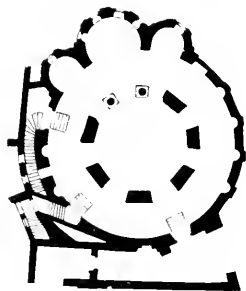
Pianta del piano inferiore del San Donato di Zara (a. 812)
